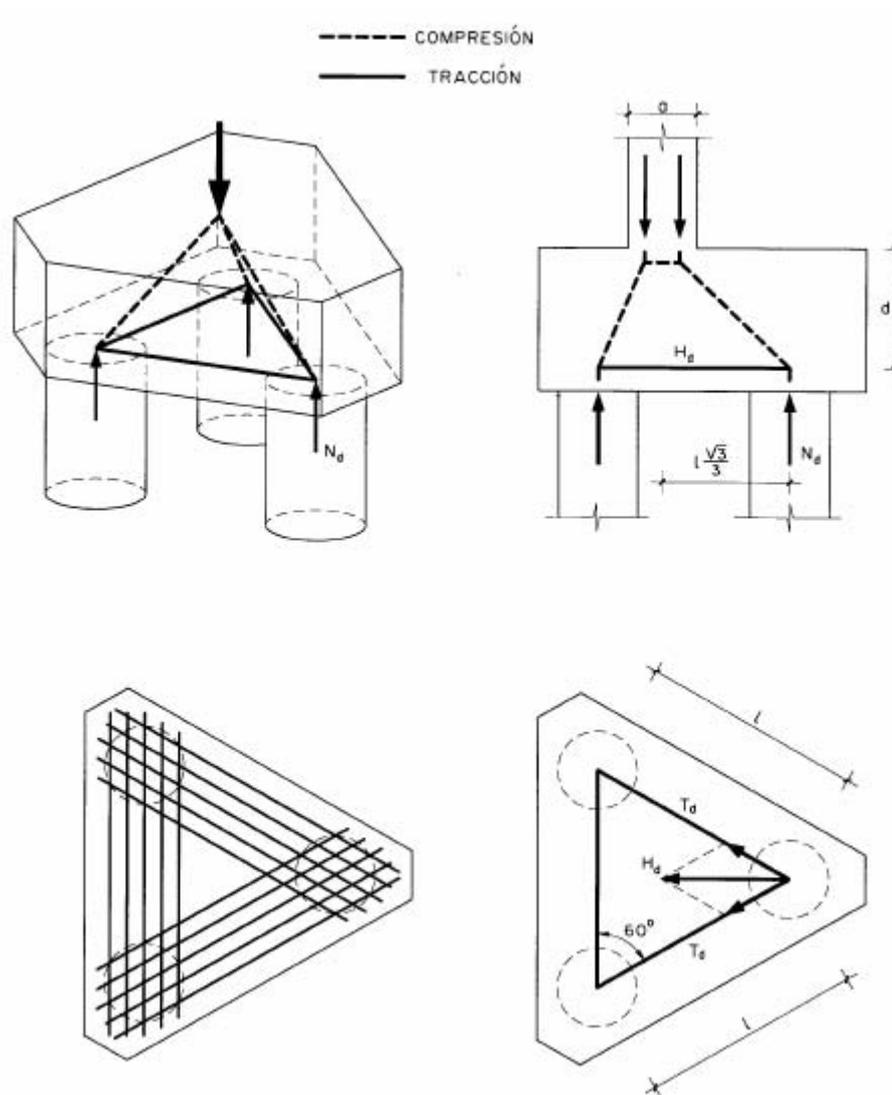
Mecanismo de tirantes y bielas en un encepado de tres pilotes.
